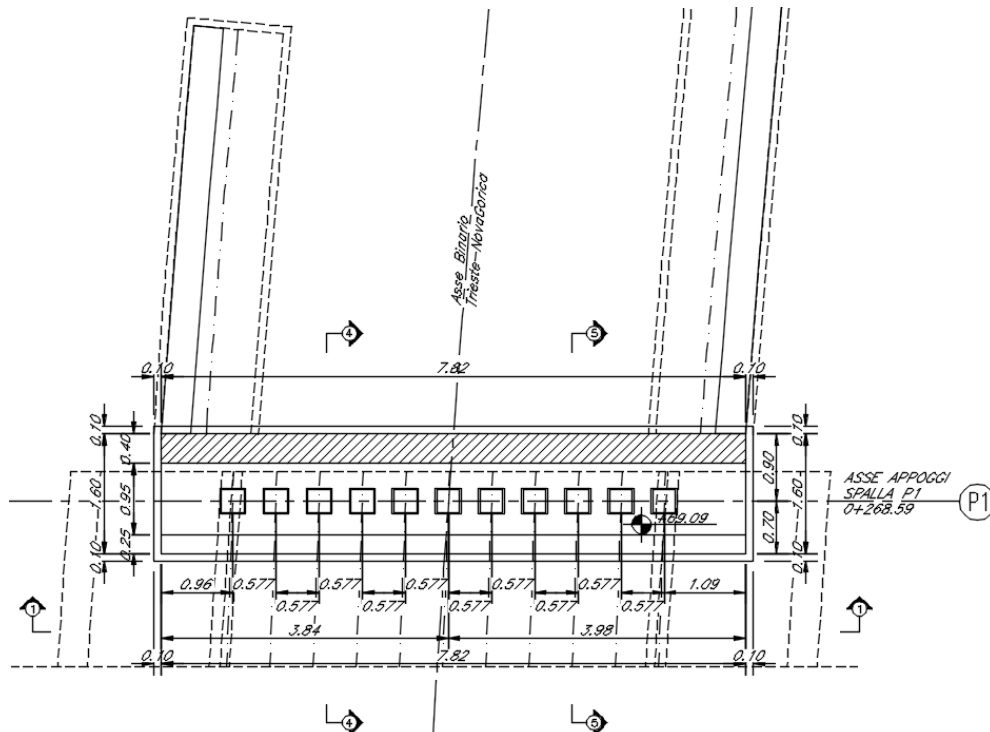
7: Spalla P1 - Sezione orizzontale 3-3 (sezione a quota appoggi)
